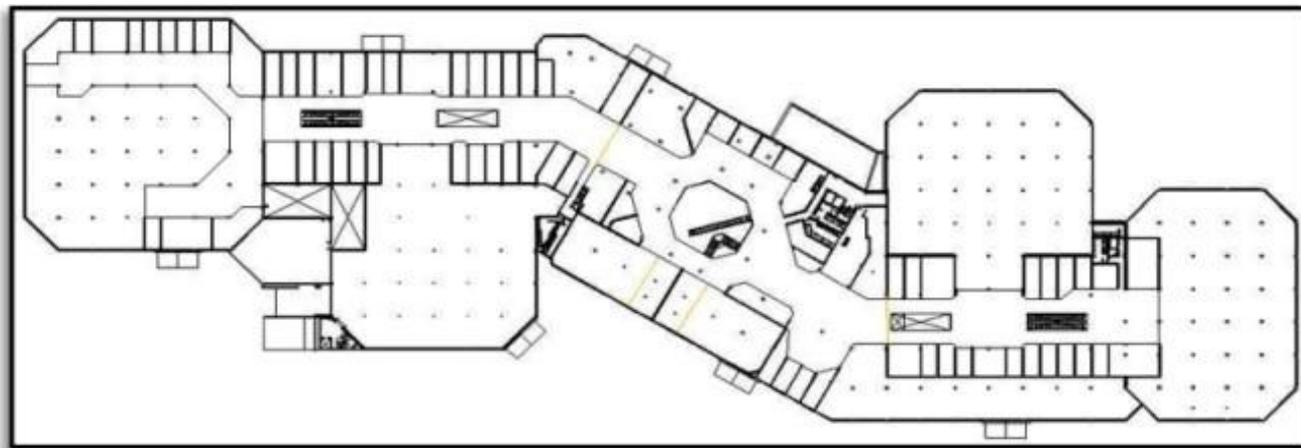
Planta baixa Shopping - Maceió Shopping, Pavimento 01 (2009).
